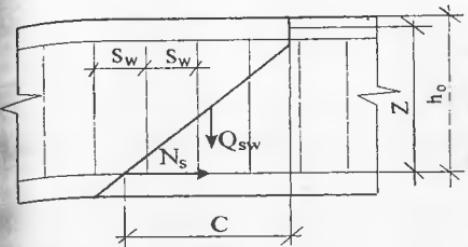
Схема при расчете железобетонных элементов по наклонному сечению на действие моментов
